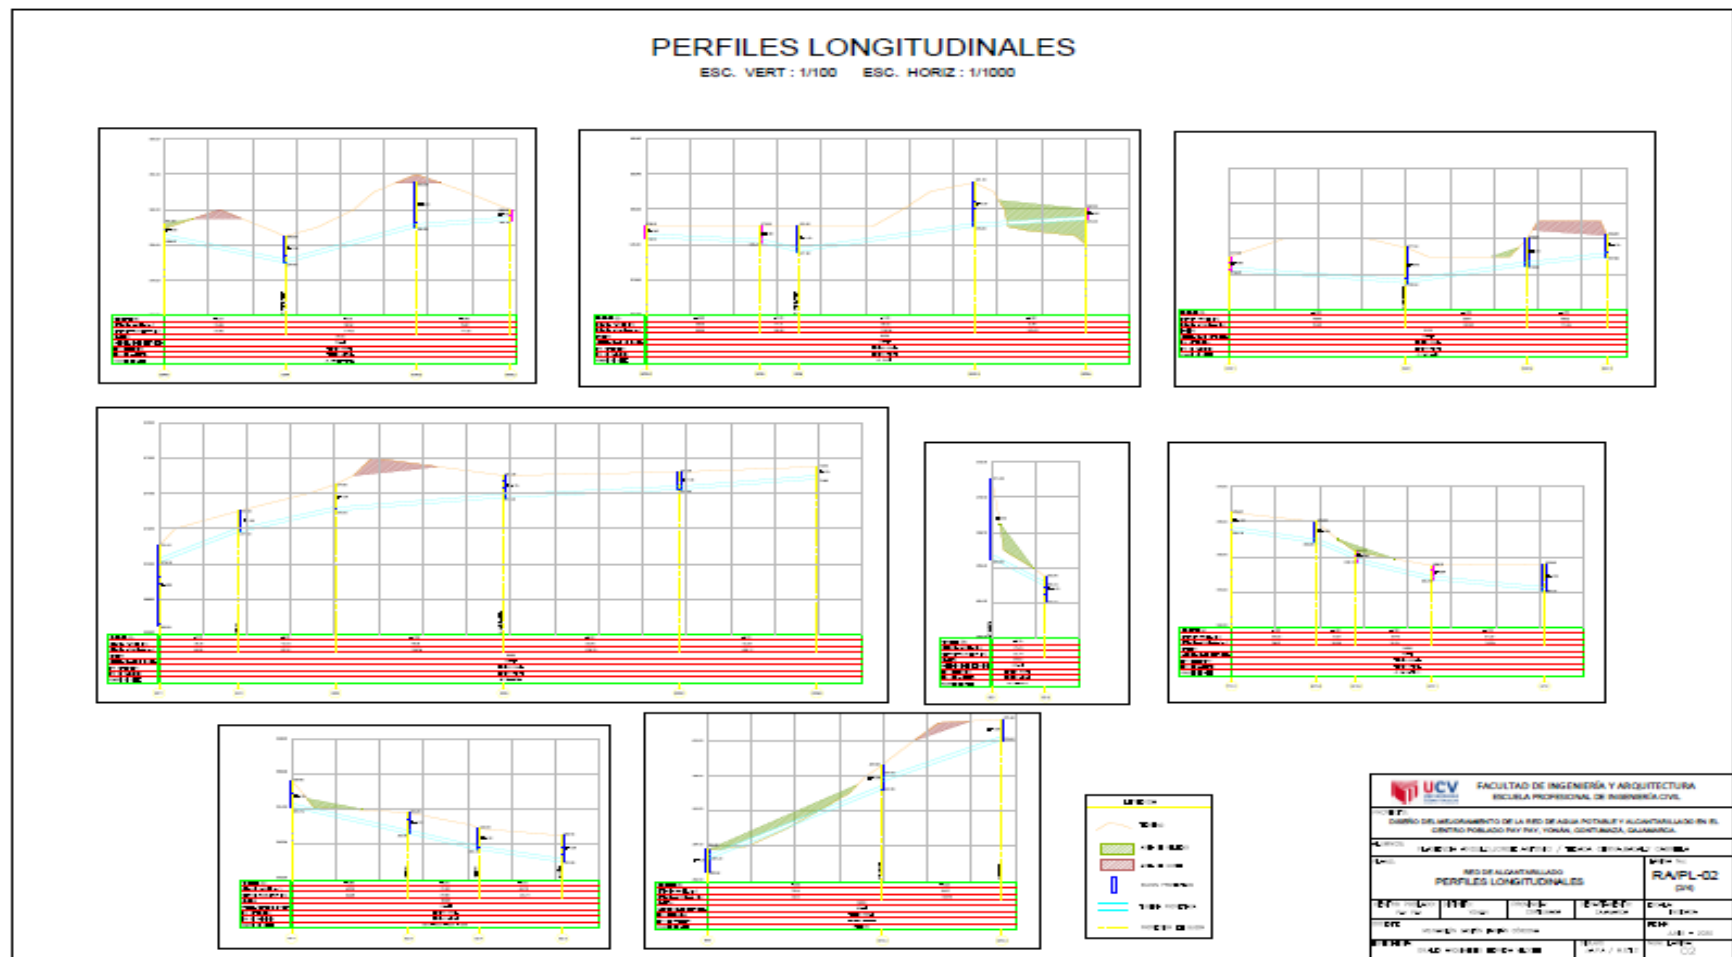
Perfiles longitudinales red de alcantarillado - parte n°02
